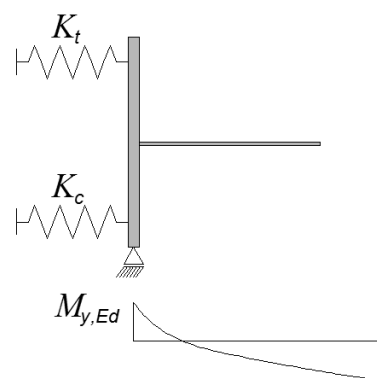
Deformovatelné komponenty pro kotvení sloupu patní a kotevní deskou
